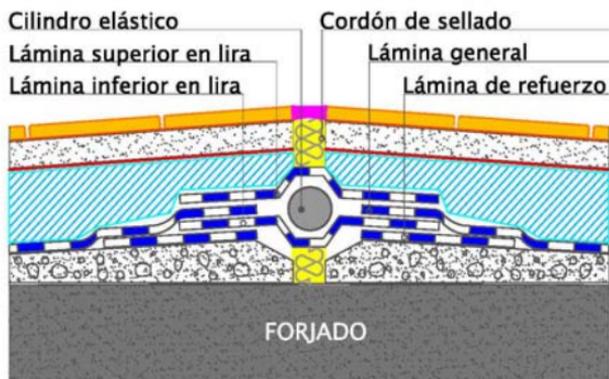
Foto K – Colocación de cilindro elástico en el interior de una junta de dilatación
